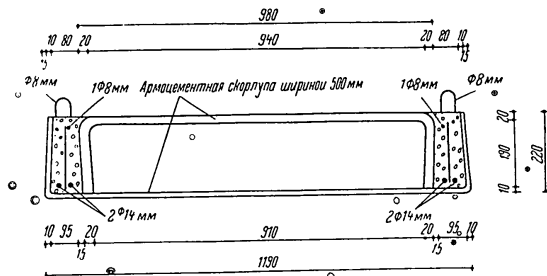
Армоцементная пустотелая панель междуэтажного перекрытия
